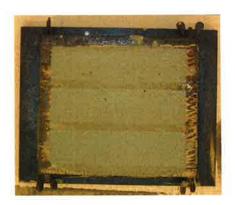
moule métallique à éprouvettes prismatiques, après remplissage
